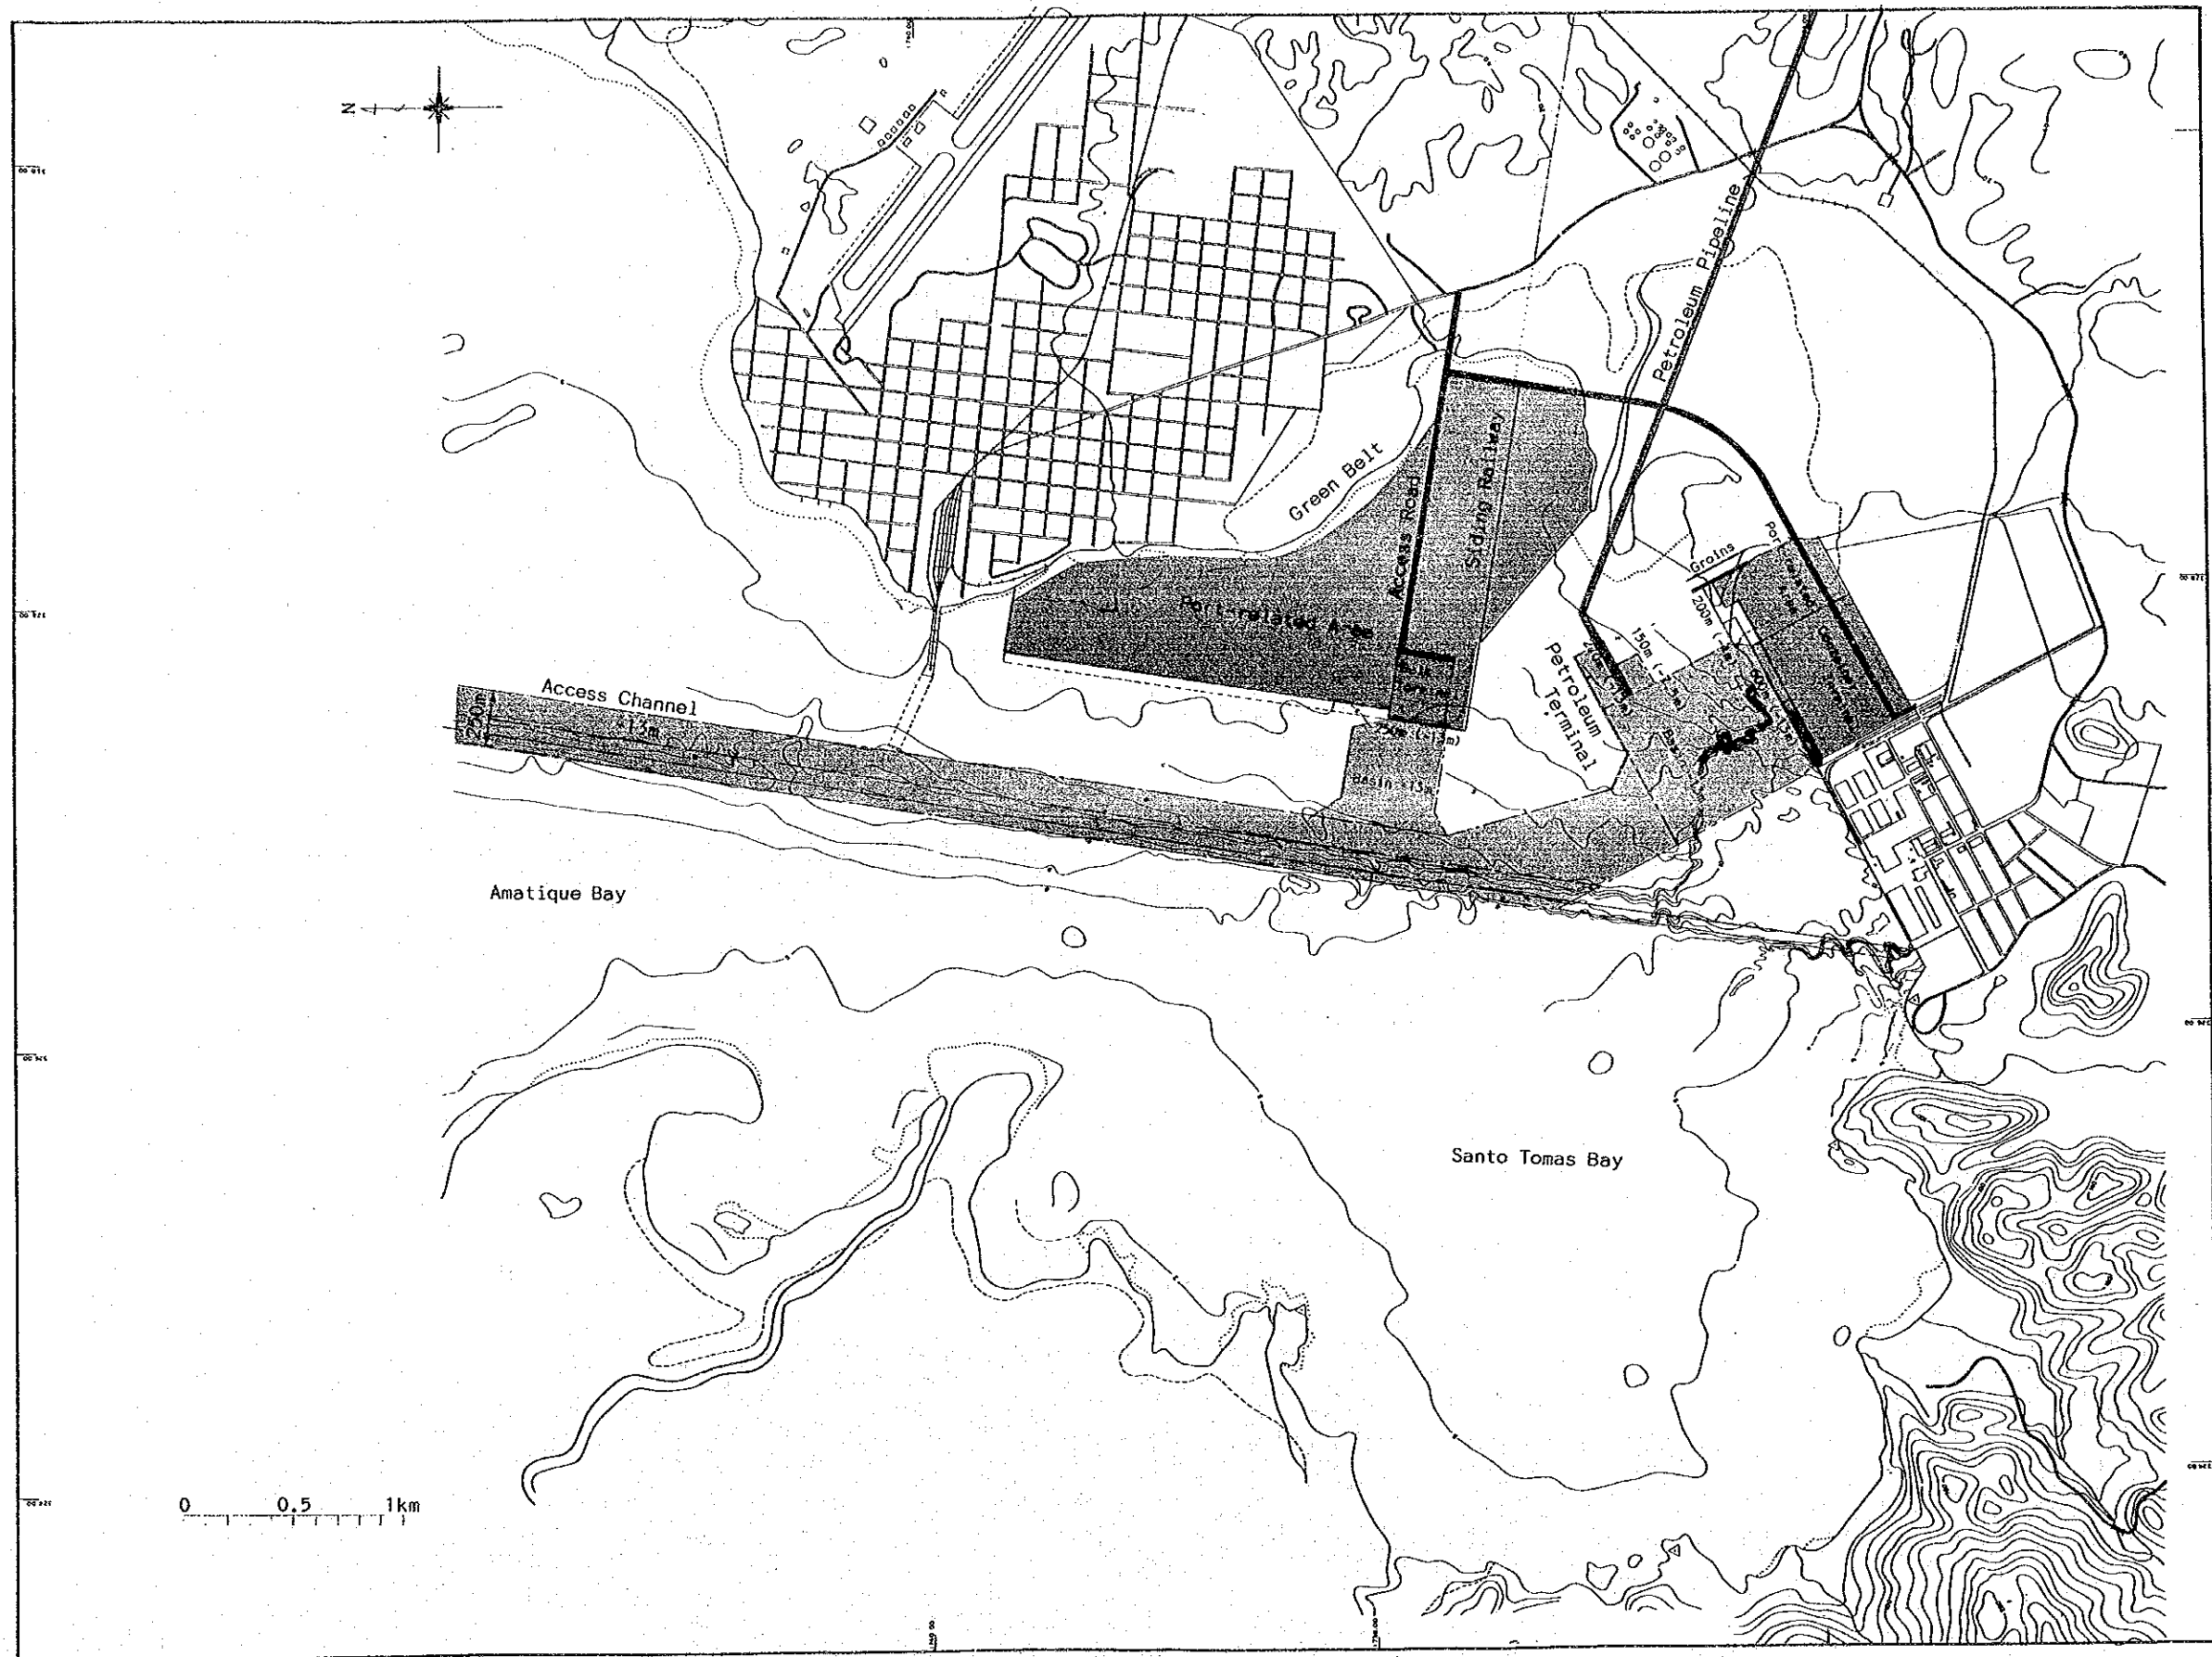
Plan Alternativo de Distribución ----Caso 1
